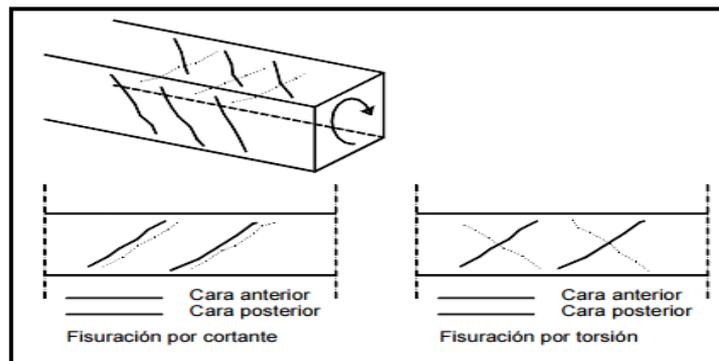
Fisuración por torsión de una viga.
